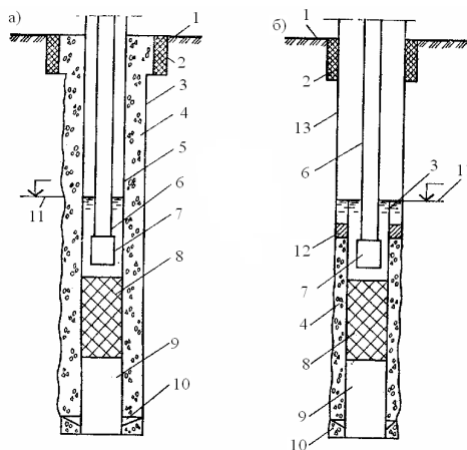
Схемы конструкций скважин вертикального дренажа.
